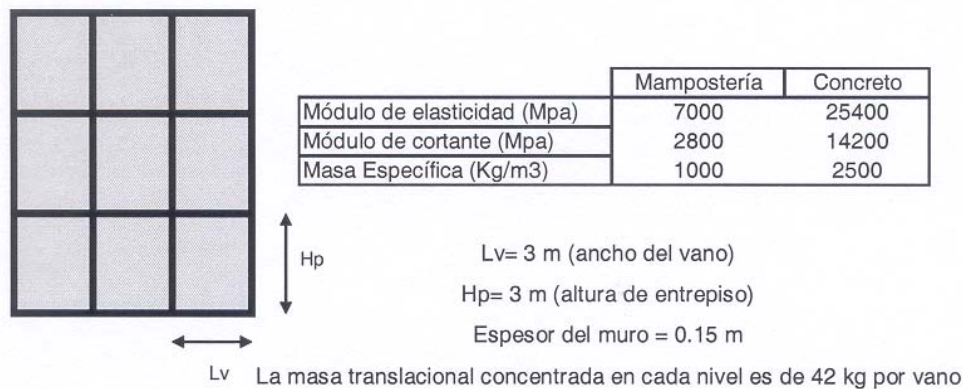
Características generales de la estructura de mampostería confinada utilizada
